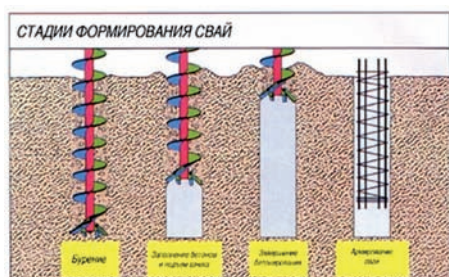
Стадии формирования свай: 1- бурение, 2 – бетонирование, 3 – завершение бетонирования, 4 – погружение каркаса
